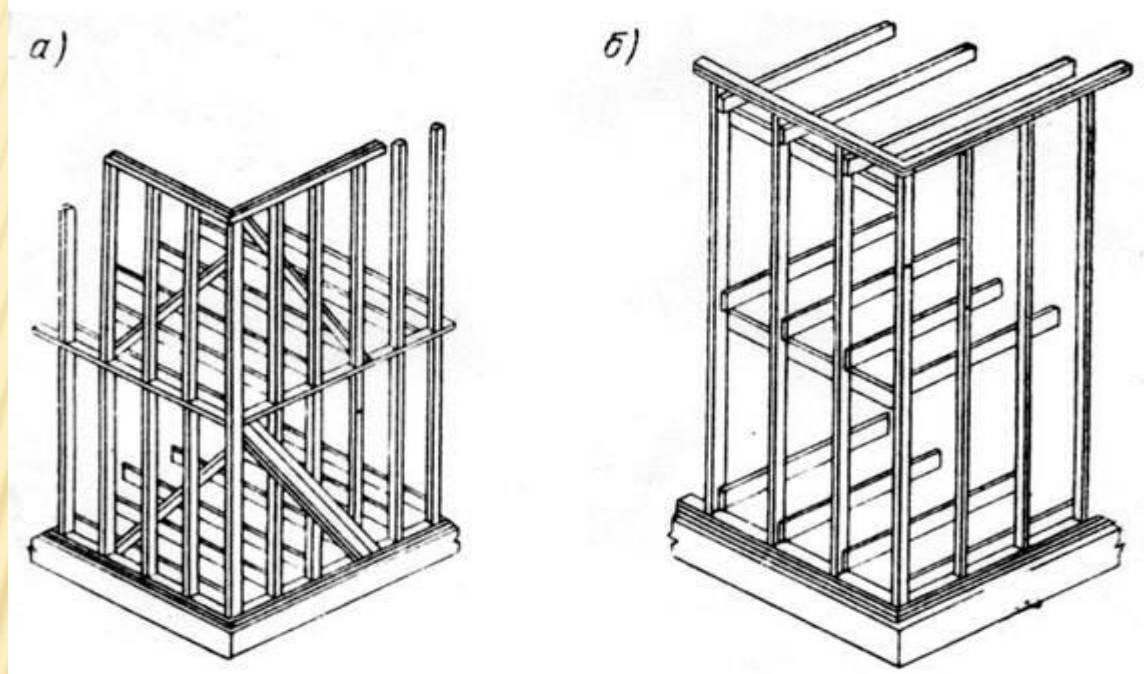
Каркас деревянного здания: а – схема деревянного каркаса с поэтажными стойками; б – то же на два этажа
